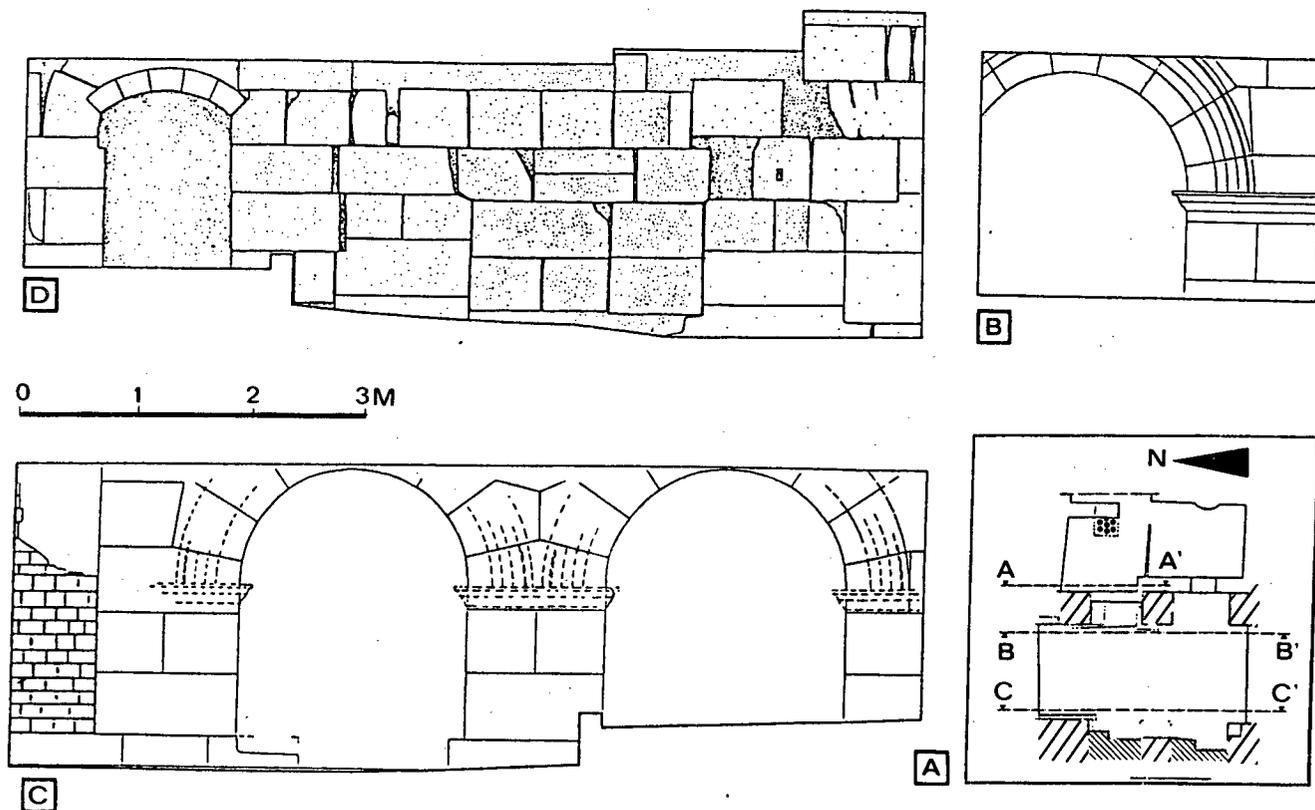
84 - AVIGNON, rue Favart. a : plan général (en pointillé, construction en petit appareil ; en trame oblique à droite, construction en grand appareil ; en trame oblique à gauche, construction en grand appareil remanié). b : coupe AA'. c : coupe BB'. d : coupe CC'.
